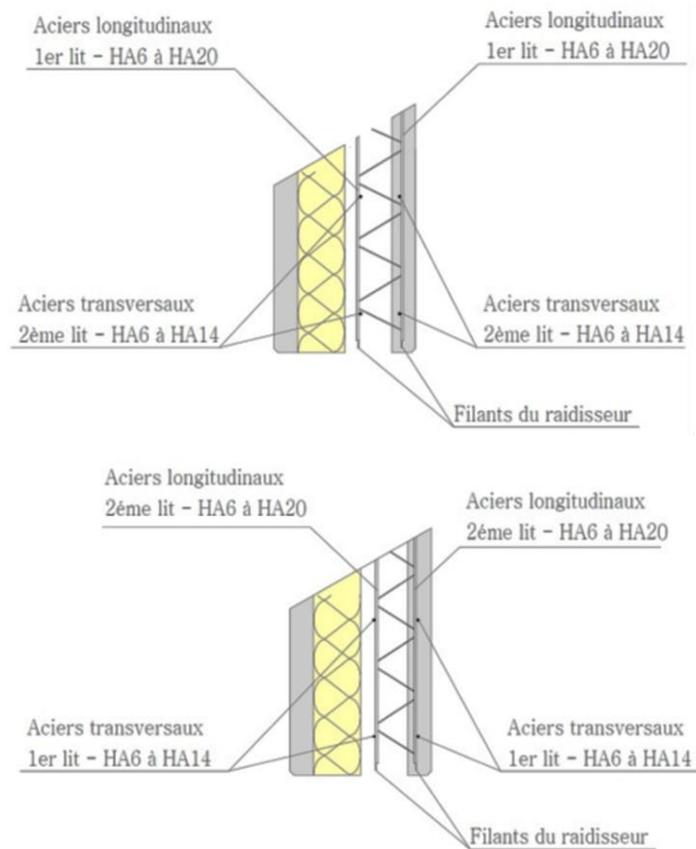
Armatures longitudinales en 1er lit    Figure 78 - Armatures transversales en 1er lit
